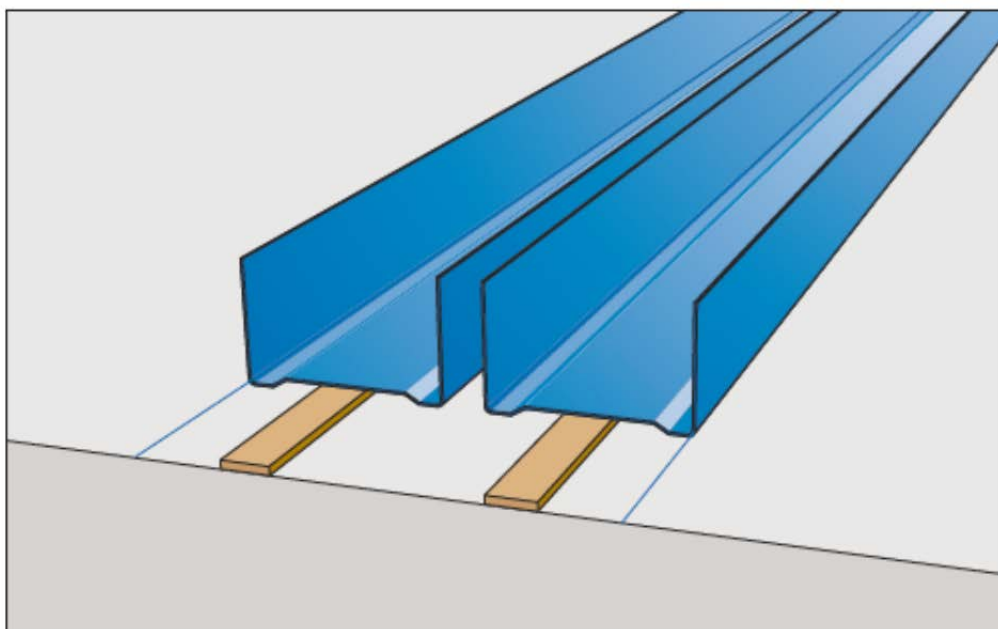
Interruption des lattes de plancher au droit de la cloison
